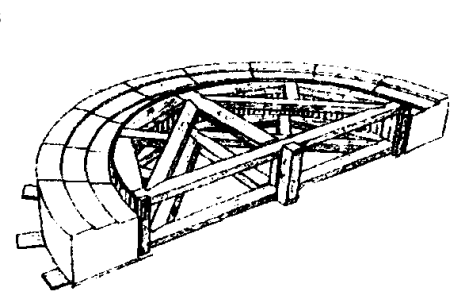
Cimbra para construcción arco. Mampostería ordinaria.
